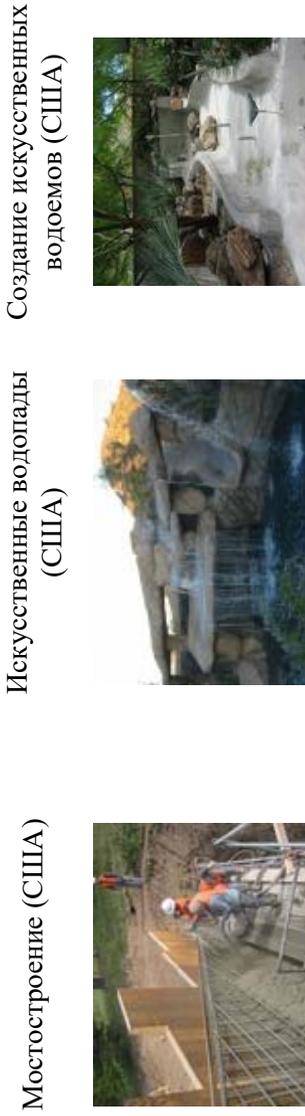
Примеры строительства зданий и сооружений из торкрежелезобетона зарубежом
